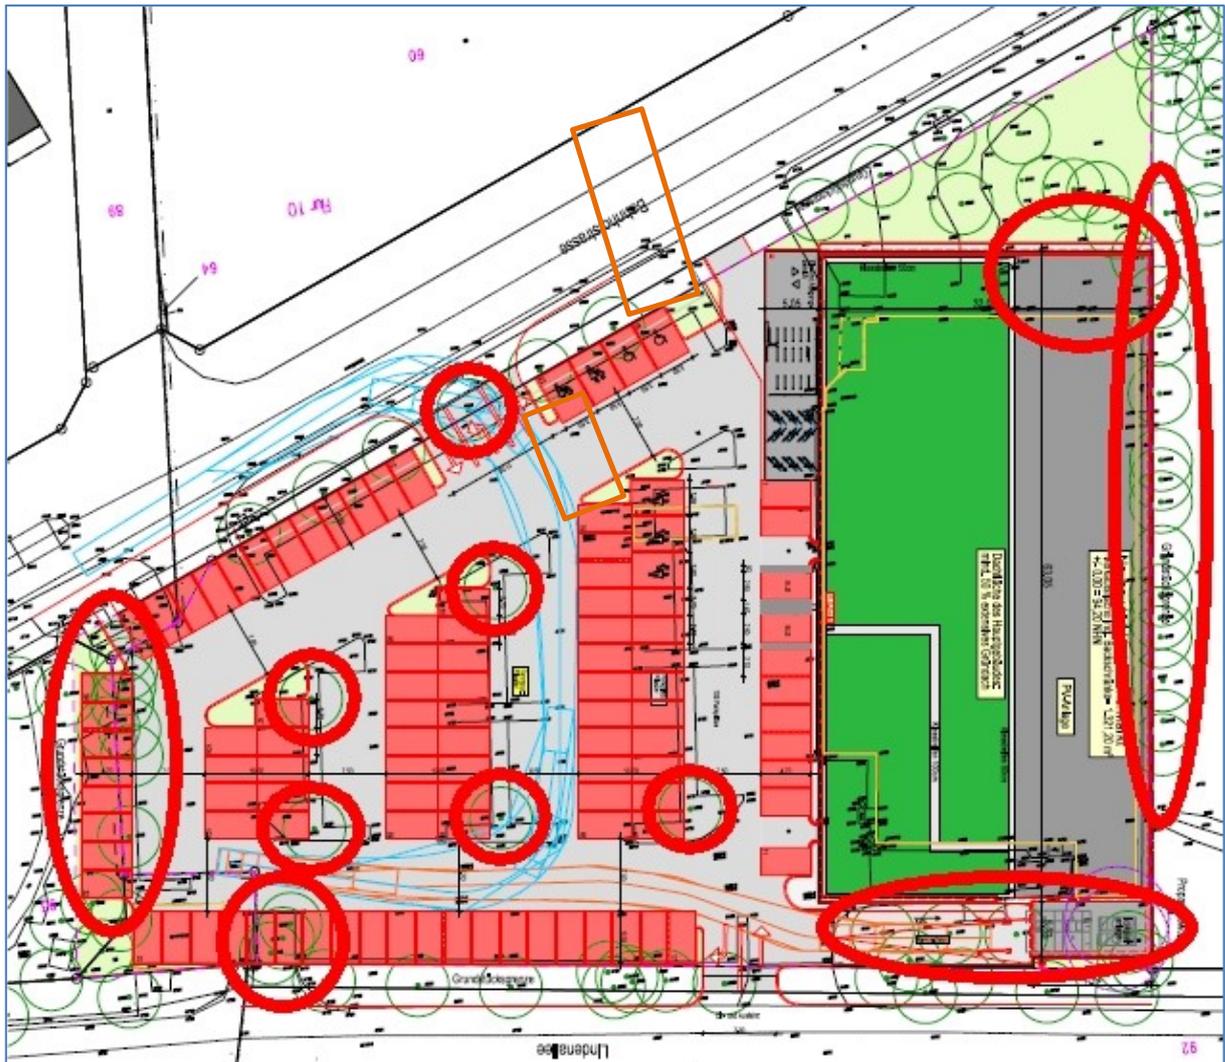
Lageplan (Entwurf), Stand 22.02.2022 mit Darstellung (rote Kreise/Ovale) der betroffenen Gehölze.
